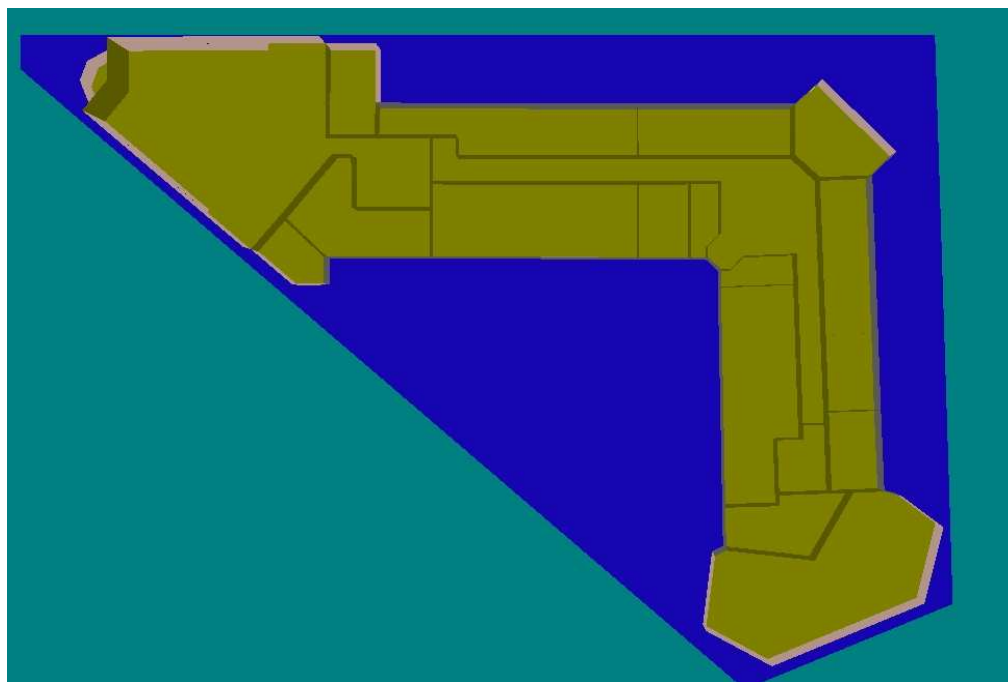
Vista en planta del edificio – LIDER. Fuente: Elaboración propia
